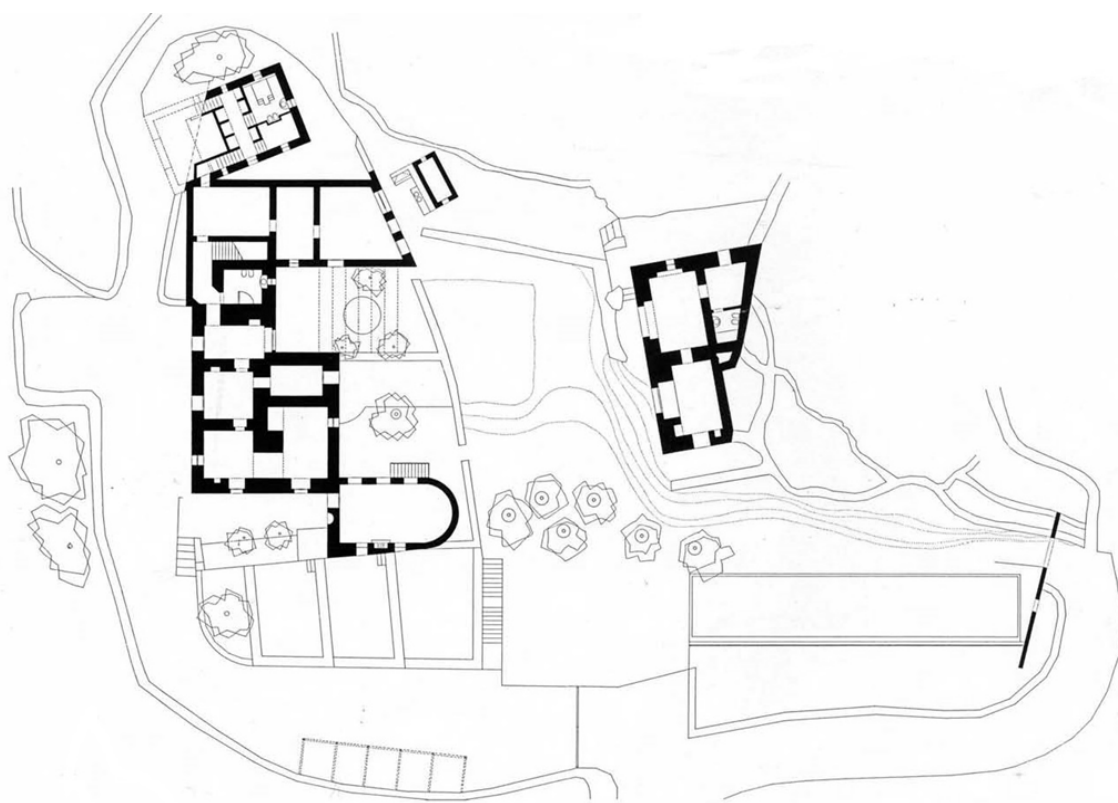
Planta geral (Albanese, 1998 p. 57).
